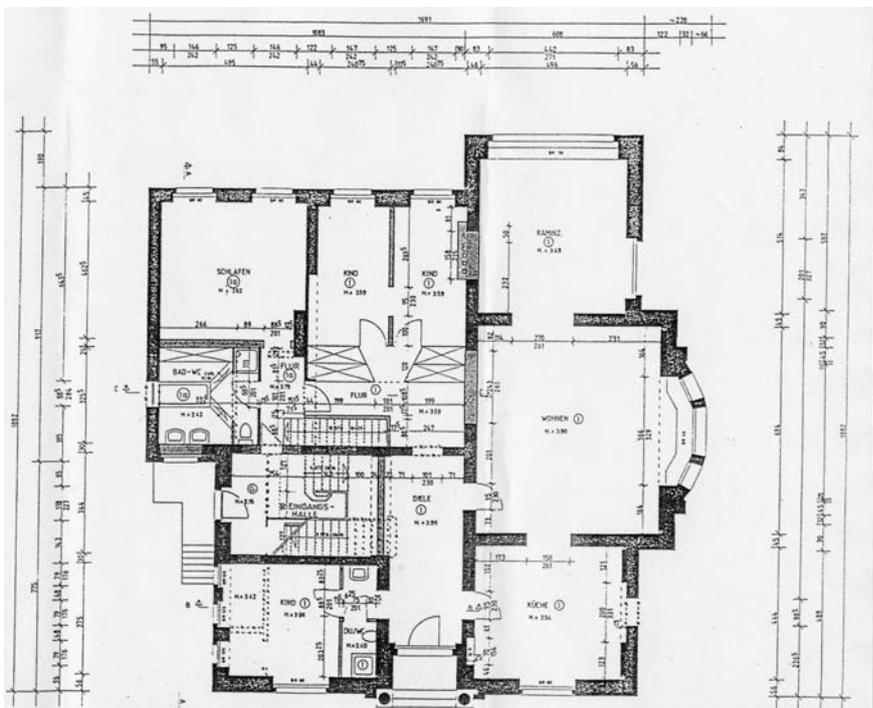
Haus Ernst, Grundriss Erdgeschoss, o. J., vermutlich 1987
